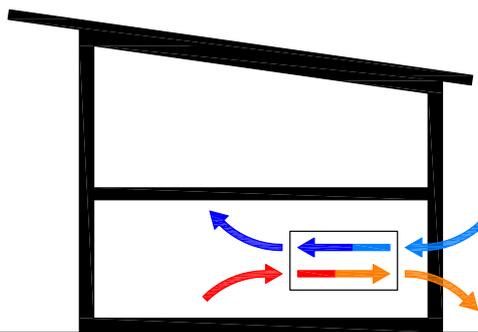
| kontrollierte Wohnraumlüftung mit hoher WRG, die ein konventionelles Heizsystem überflüssig macht
